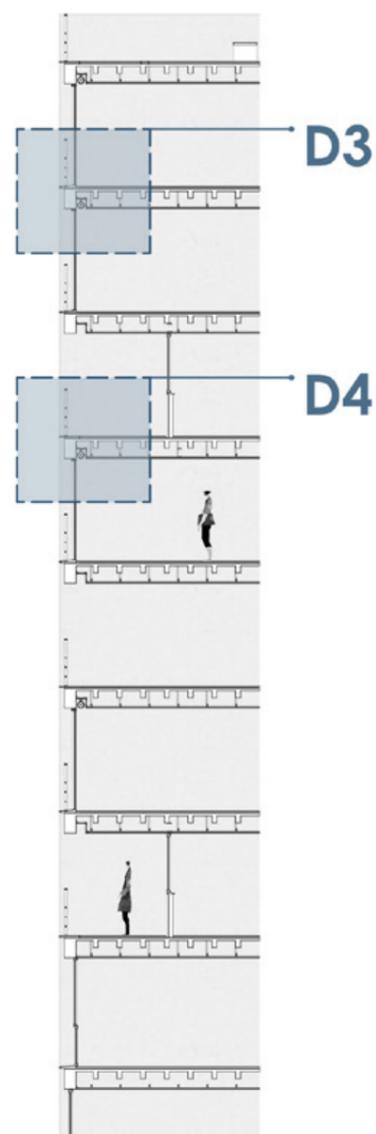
Sección constructiva correspondiente a fachadas internas del proyecto. Fuente: Elaboración propia.
